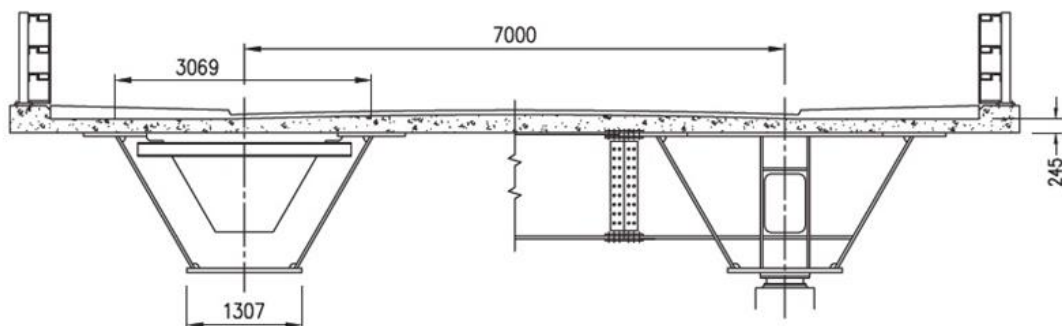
Pontes mistas com caixão metálico em secção aberta (steelconstruction.info)
